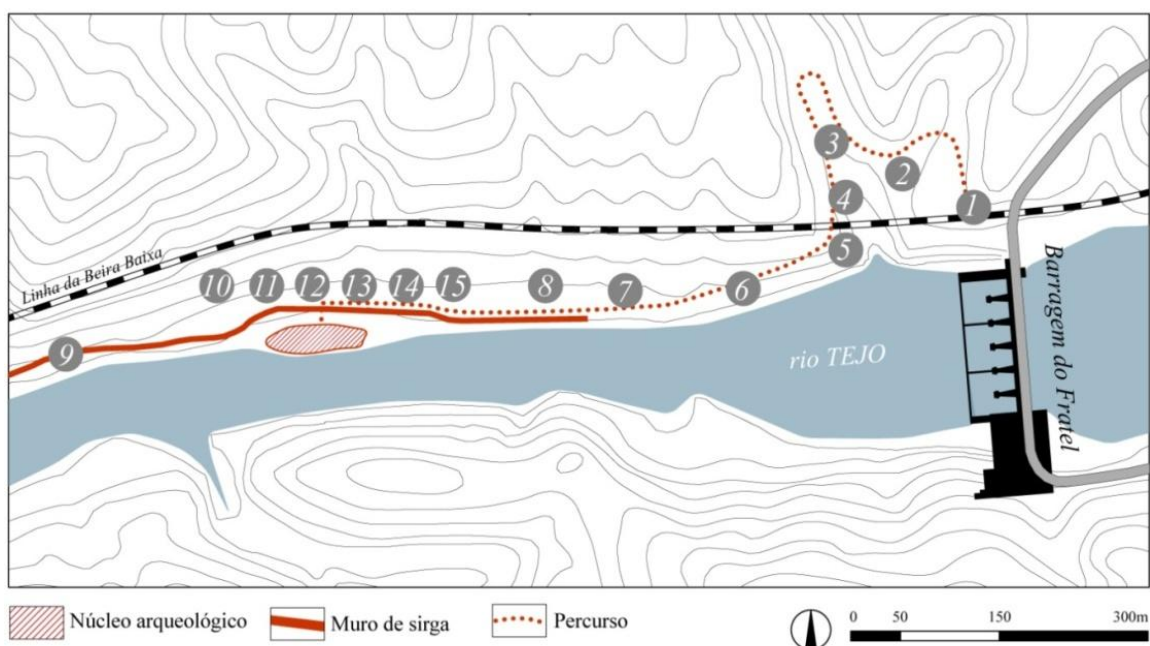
Planta da 1ª solução proposta para o núcleo de Gardete
